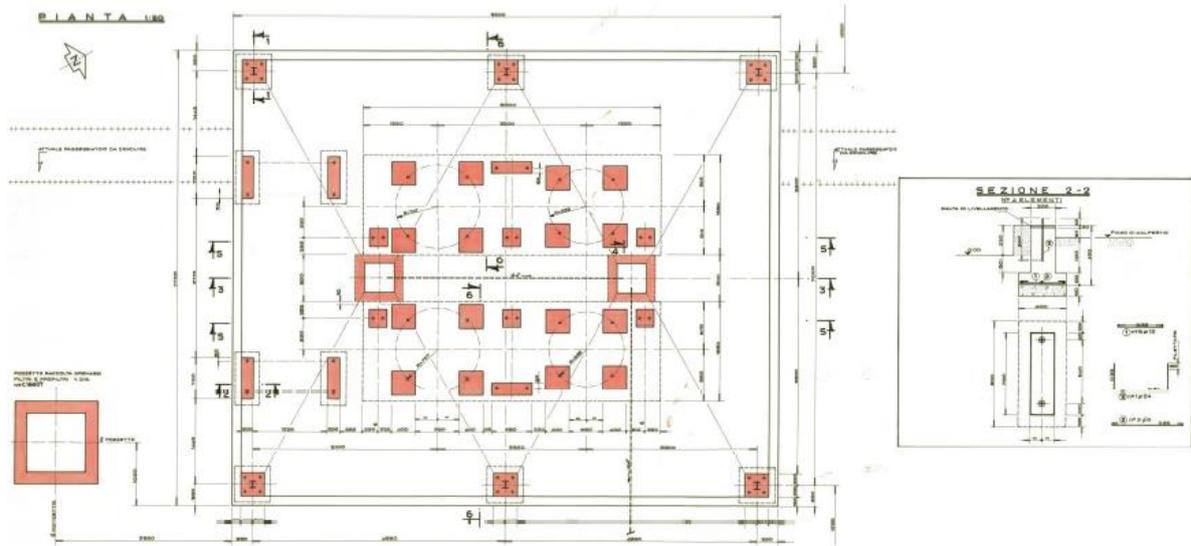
Area filtri e Prefiltri Avgas – (Pianta e Dettagli delle Fondazioni)
